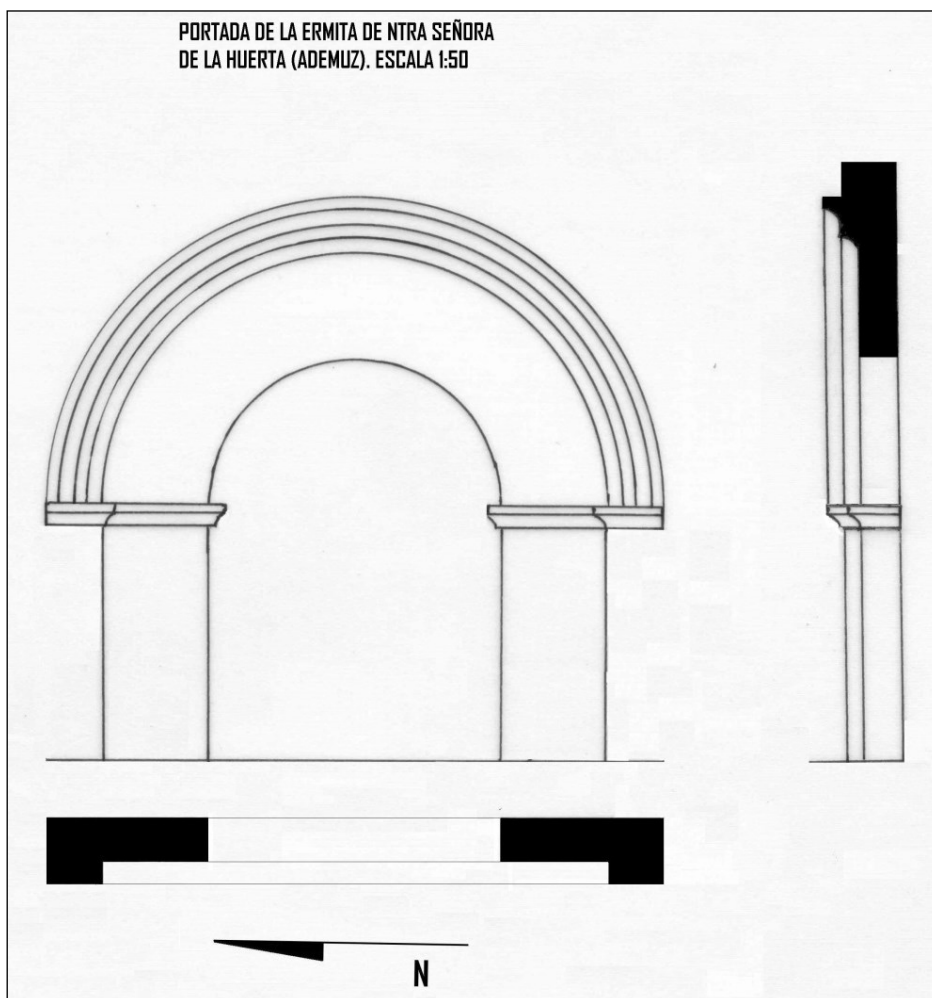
Diseño de la portada en planta, alzado y perfil (F.J. Soriano).
